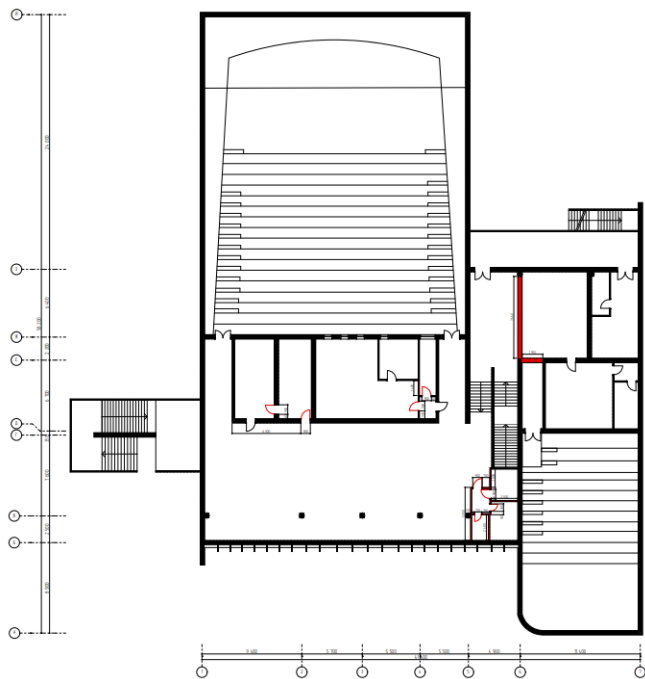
Схема демонтажу перегородок 2-го рівня
